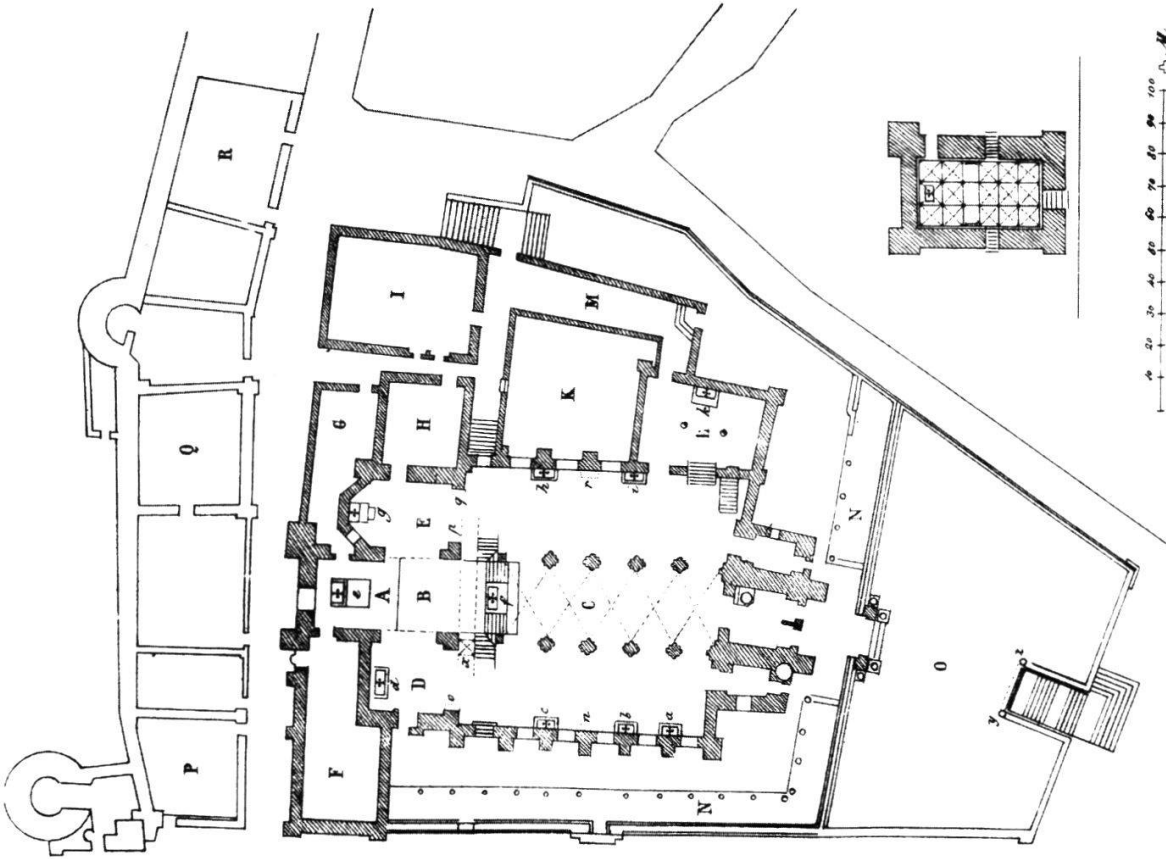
Grundriß der alten St. Ursen-Kirche und Erklärung des Grundrisses.
